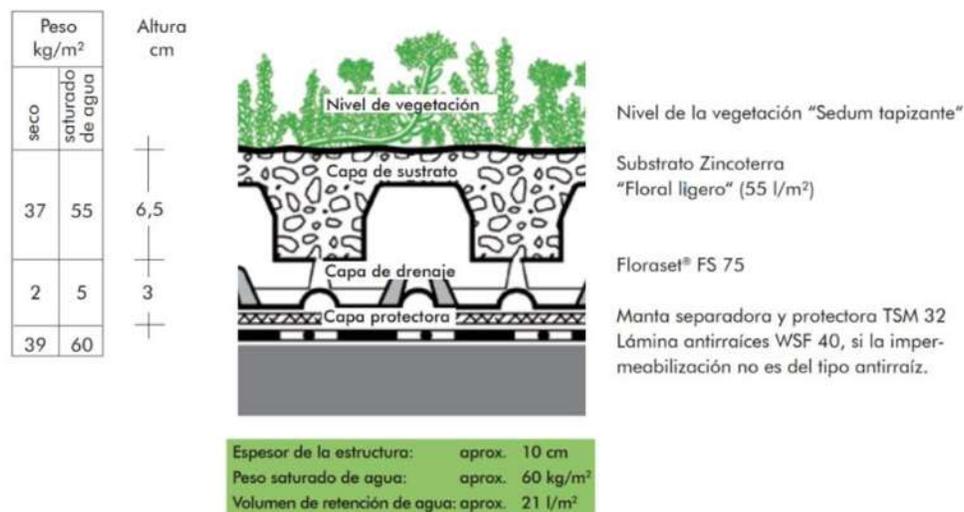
| Sistema de cubierta verde extensiva hasta una inclinación de la cubierta de 5°.
